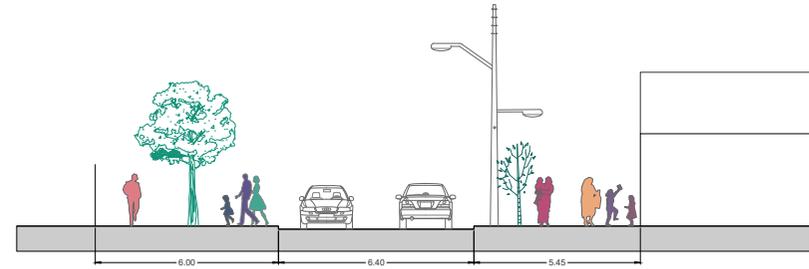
Perfil vial esquemático de calle Santa Petronila.
